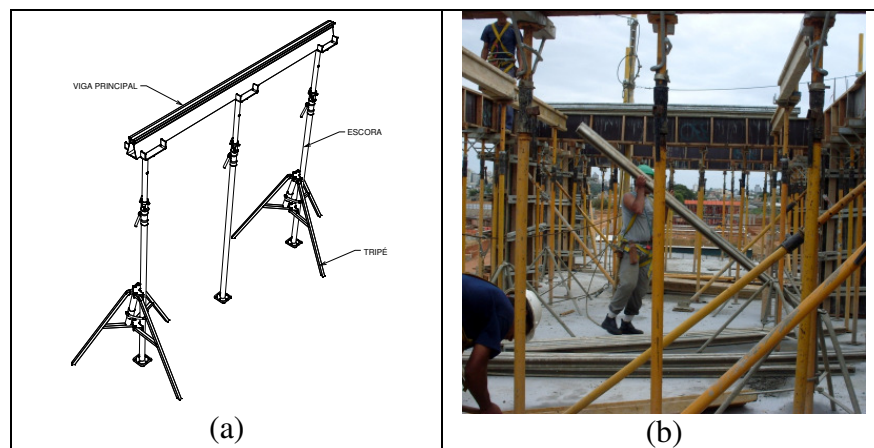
desenho e foto ilustrativa do escoramento do vigamento principal das lajes
